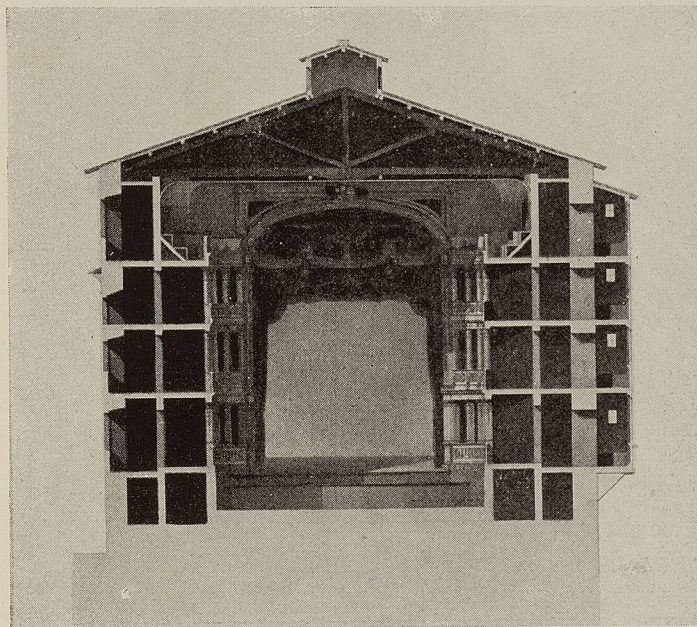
Sezione trasversale del « Caio Melisso » nel progetto di restauro del 1877.
